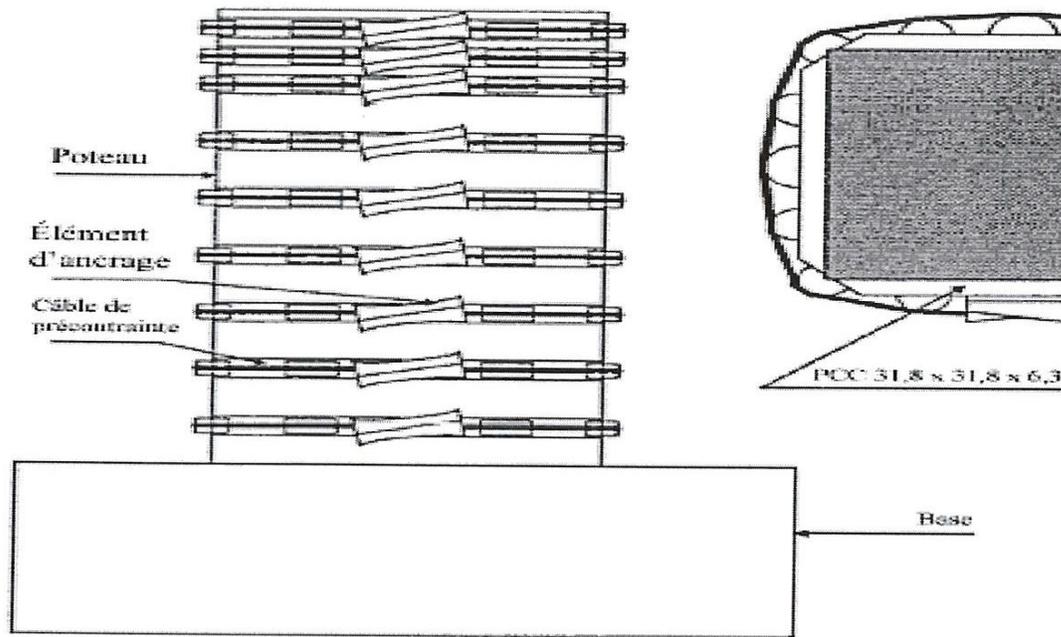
Renforcement d'un poteau carré à état de cisaillement dominant [13].
